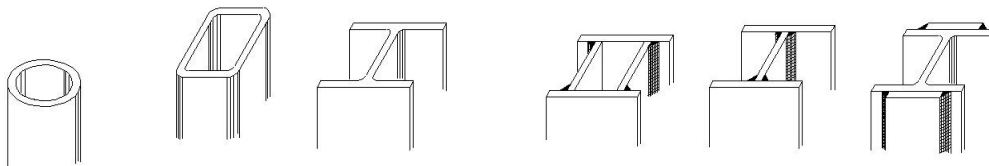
Secções laminadas e soldadas.
